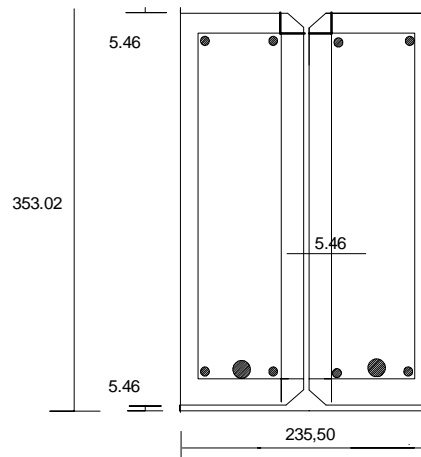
Seção Transversal da Viga VS1 (dimensões em mm)
